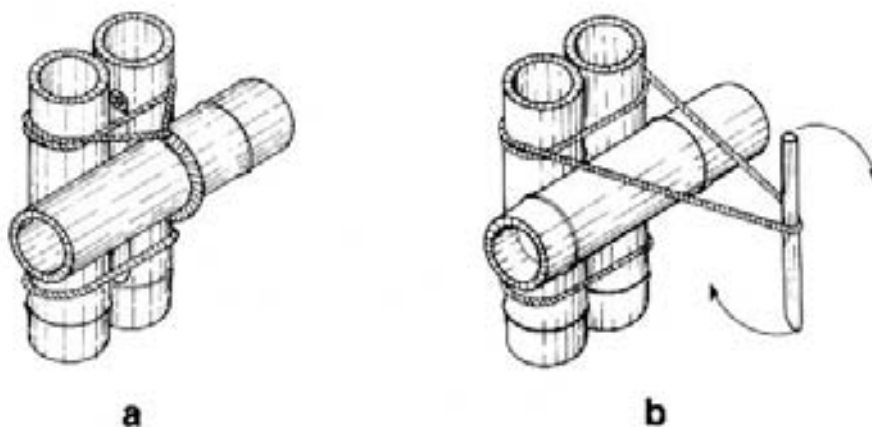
Amarrações entre vigas e colunas de bambu.
